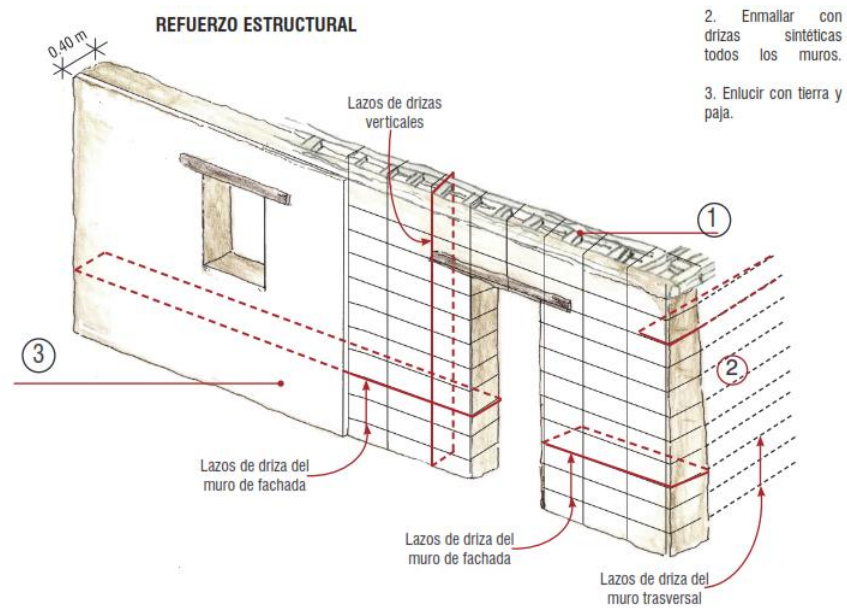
Se tiene que reforzar todas las grietas con drizas propuestas o Geomallas existentes en el mercado para tal fin.
